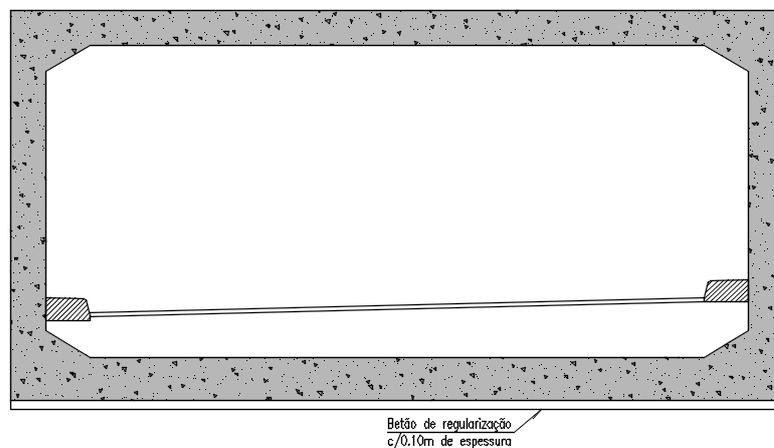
Corte transversal tipo do túnel de ligação à rotunda.
